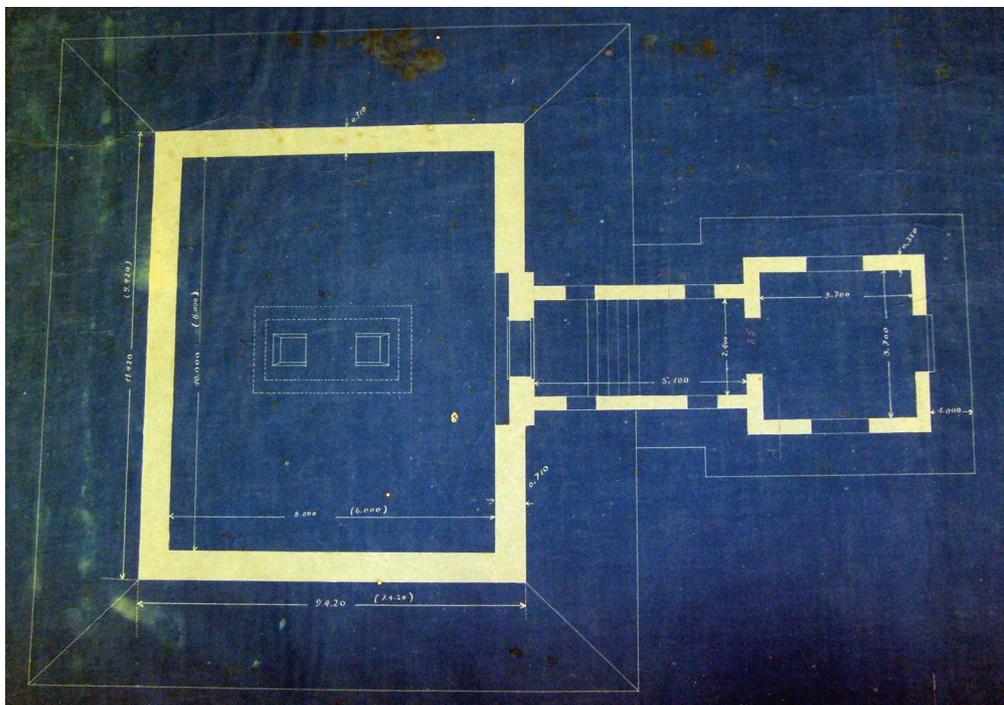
Planta baixa. Desenho original do pavilhão da luneta meridiana de Gautier. Arquivo MAST, Rio de Janeiro.
